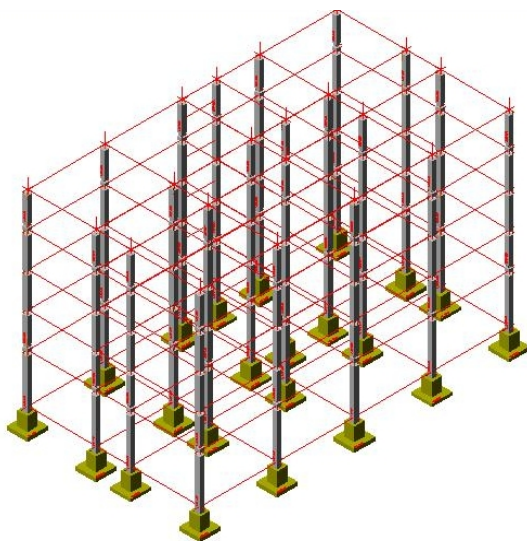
Установка сборных железобетонных колонн и монолитных фундаментов в проектное положение
